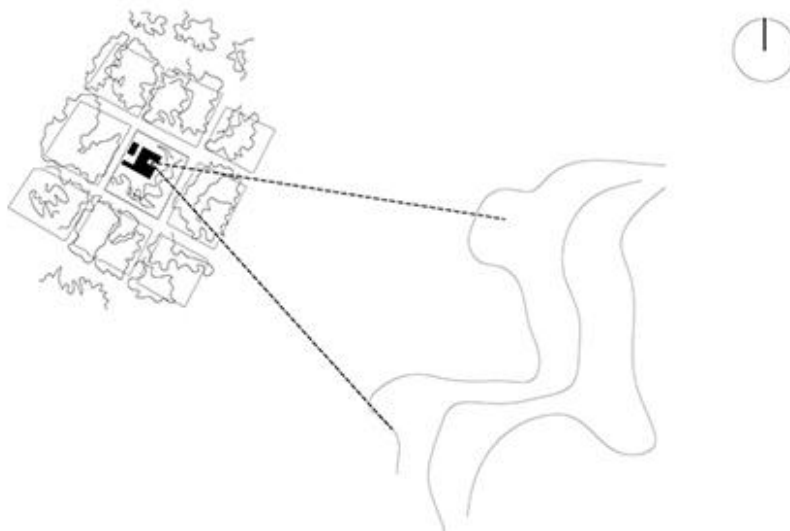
Schema planimetrico delle relazioni che la casa stabilisce con il tessuto della città e le montagne.
